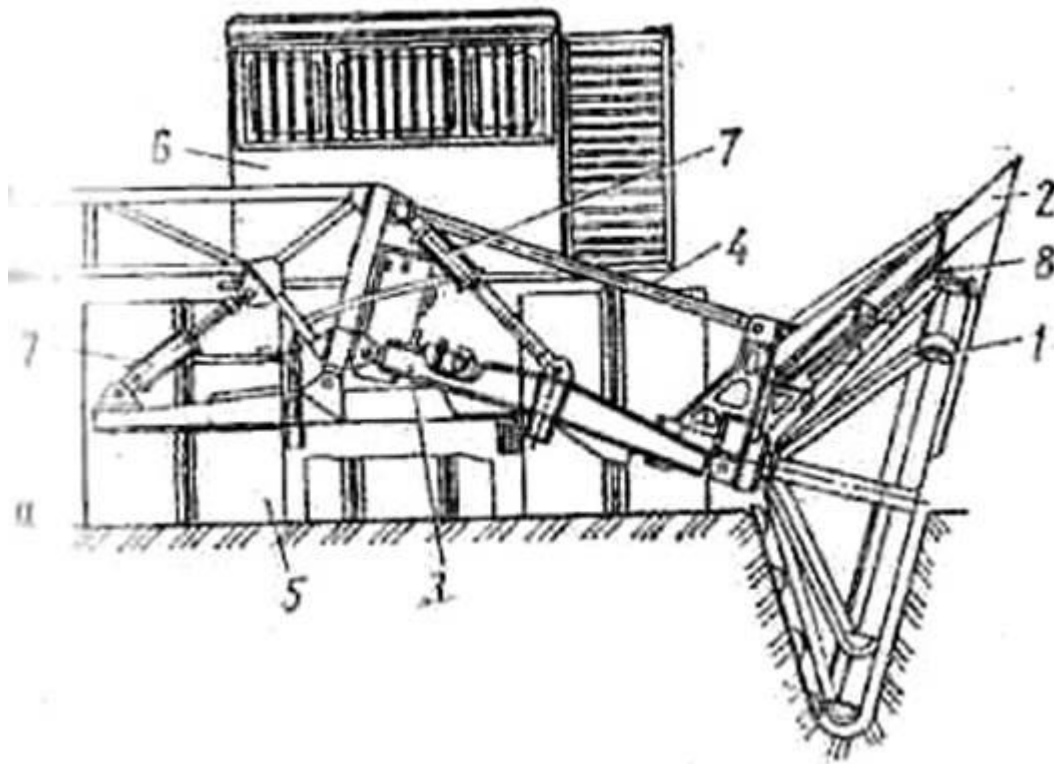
Причіпний фрезерний каналокочач з копіювальною фрезою: 1 – фреза; 2 – напрямний козирок; 3 – виносна рама (стріла); 4 – верхній важіль навіски; 5 – опорні котки; б – трактор; 7 – гідроциліндр; 8 – чашковий ніж.
